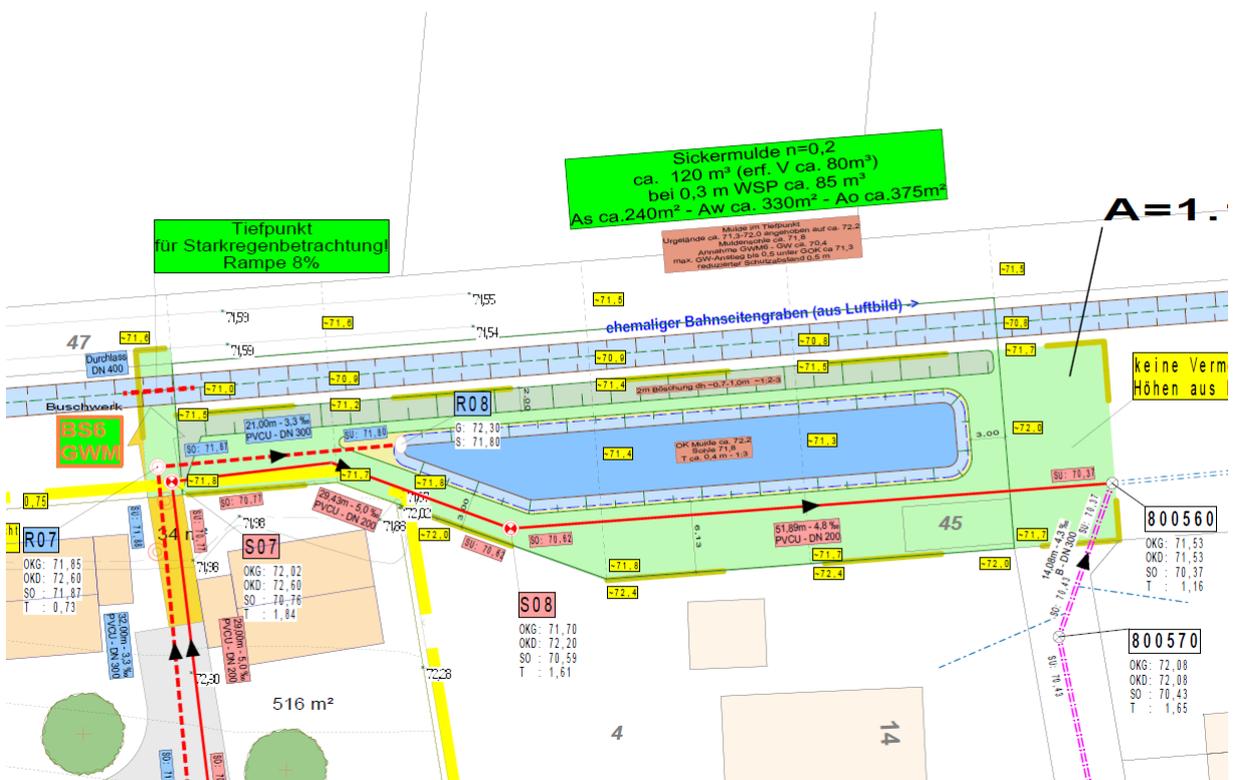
Ausschnitt Lageplan der geplanten Sickermulde nordöstlich des Plangebietes, ohne Maßstab (Quelle: Gnegel GmbH, Januar 2022)
